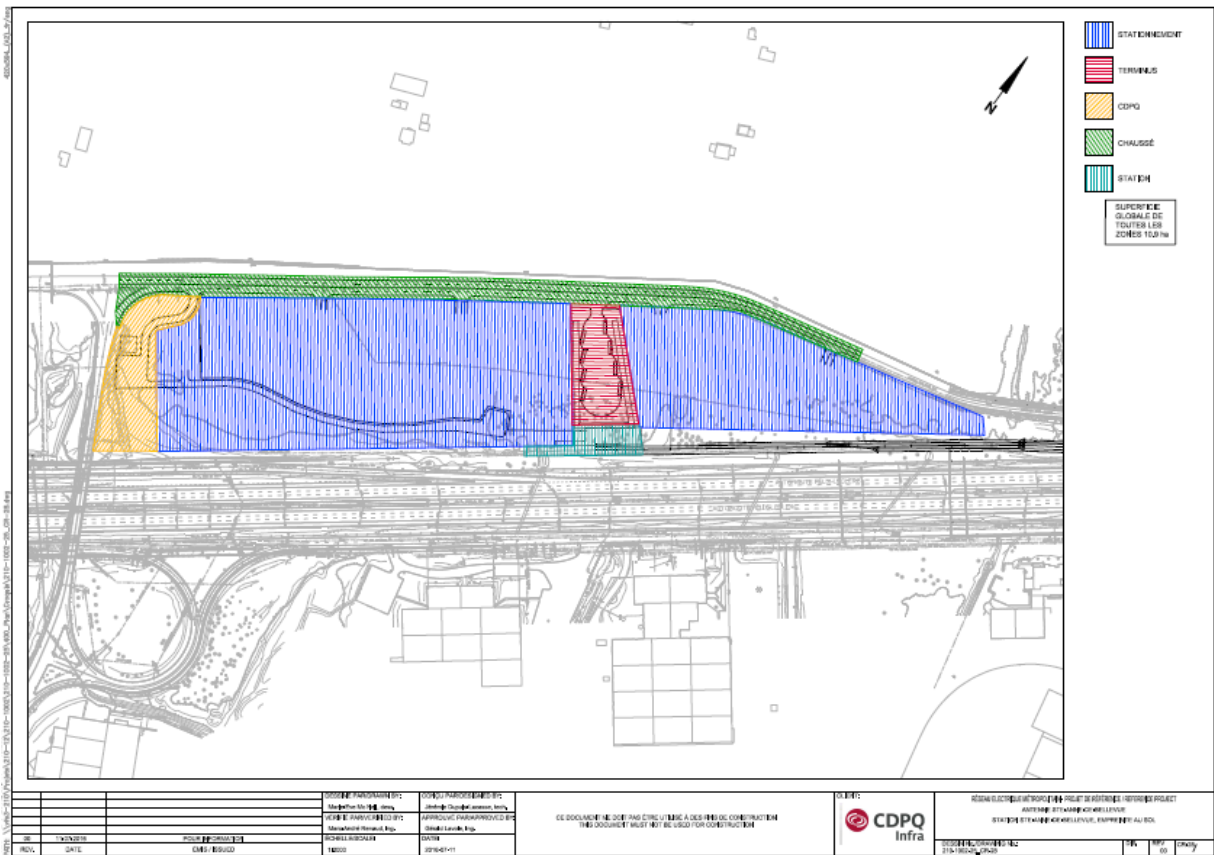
Plan préliminaire d'implantation de la station terminale Sainte-Anne-de-Bellevue
